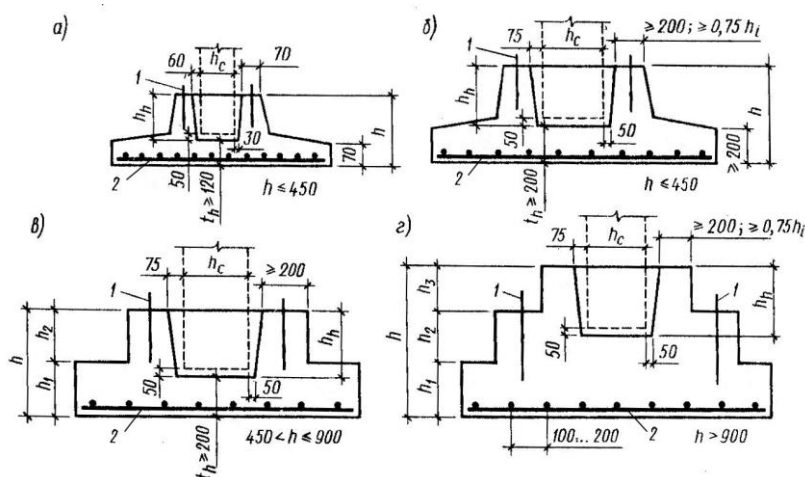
Поперечный профиль и армирование сборных отдельных фундаментов под колонны: а – пирамидальный фундамент под стойку лоткового канала; б – пирамидальный фундамент под стойку производственного здания; в, г – ступенчатые фундаменты; 1 – монтажные петли; 2 – арматурная сетка
